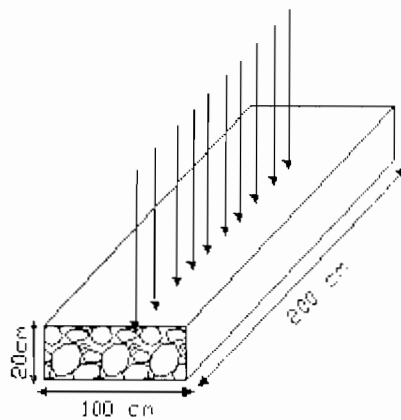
Modélisation de la paroi latérale sous forme de poutre
